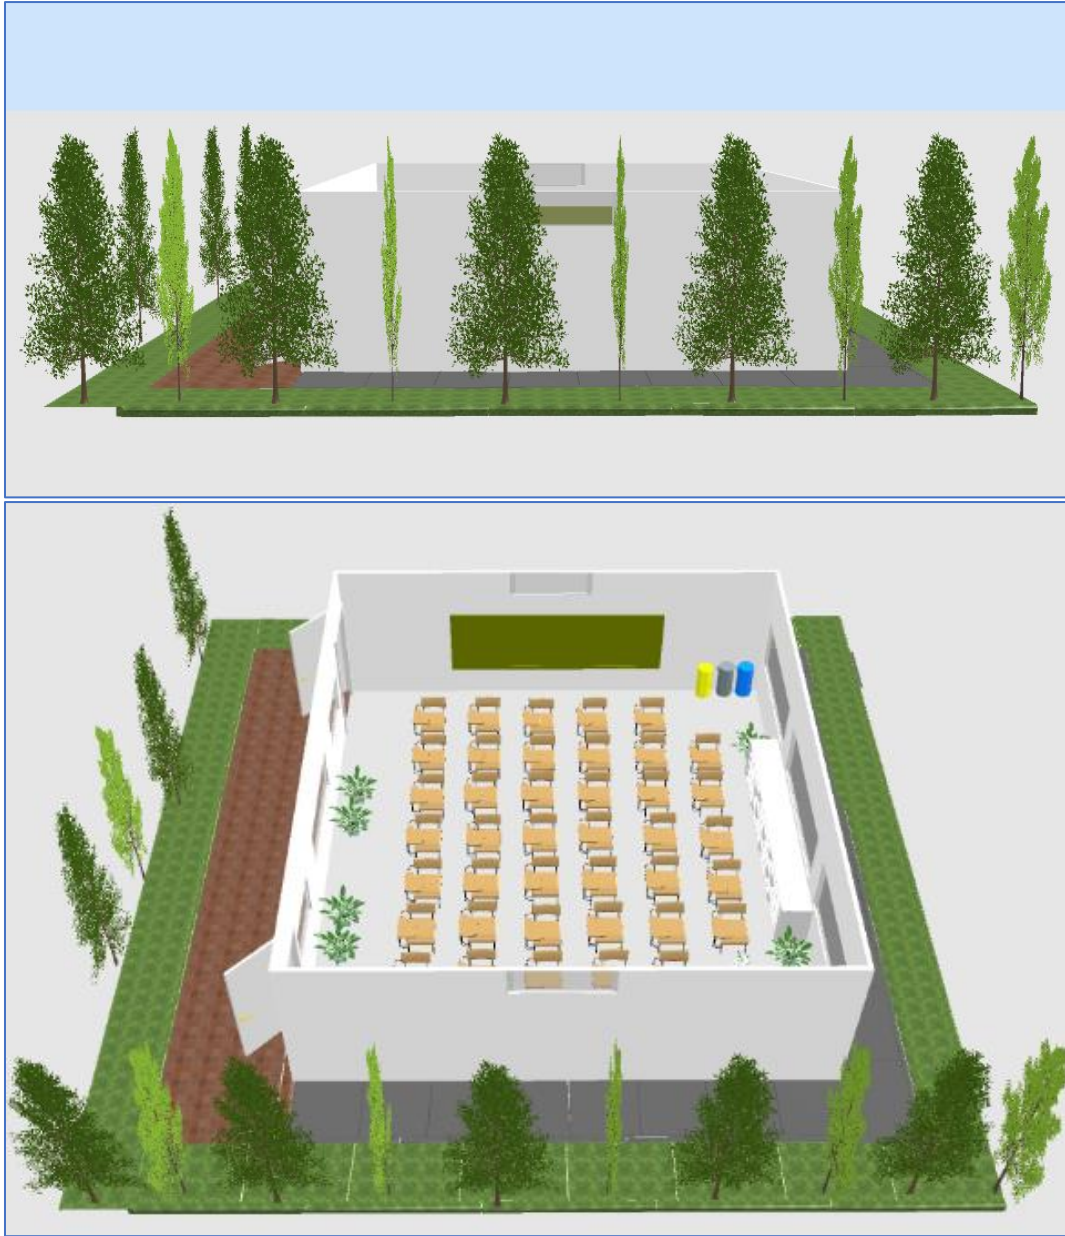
Fachada sureste del aula: vista frontal y aérea.
